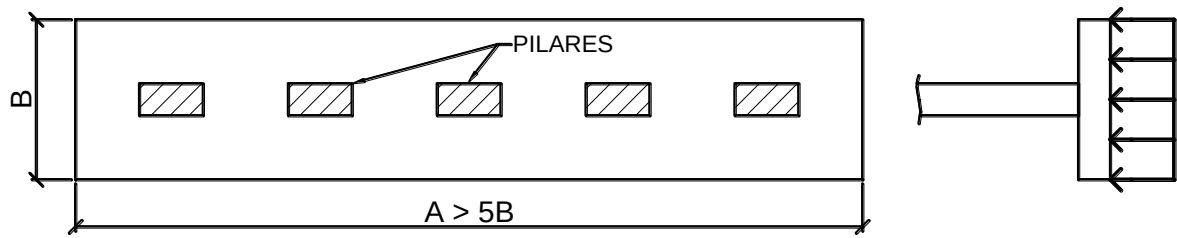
Sapata corrida para apoio de pilares alinhados.
